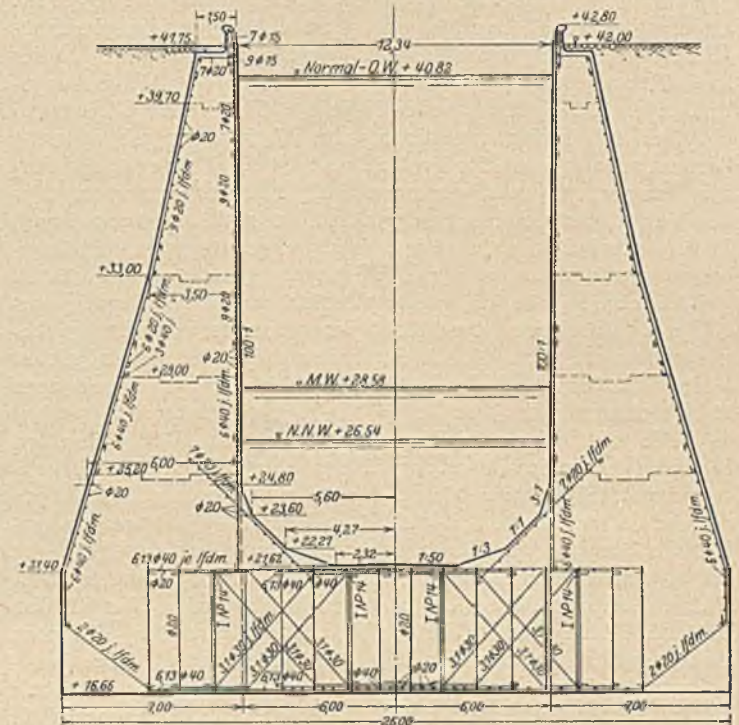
Kammerquerschnitt mit Eisenbewehrung.
